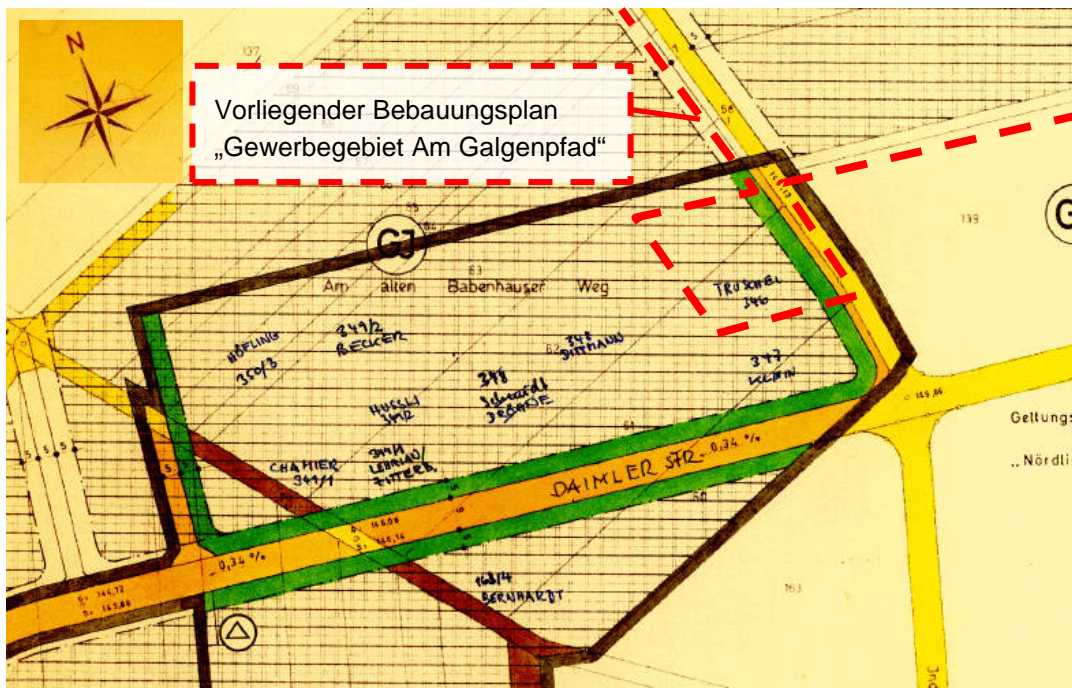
Bebauungsplan für das Industriegebiet II „Nördlich der Babenhäuser Straße“
